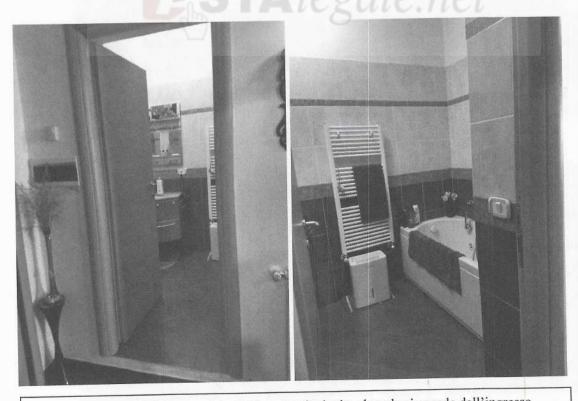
e 19. Vista parziale del bagno principale, al quale si accede dall'ingresso
